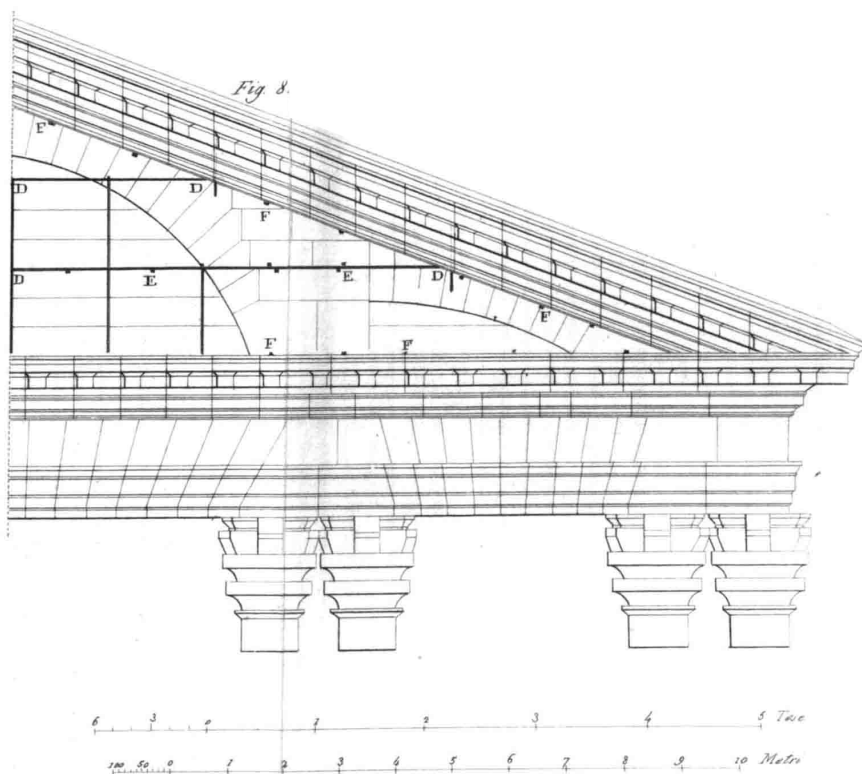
Armatura a catene, tiranti e ramponi del frontone che termina l'avancorpo centrale del colonnato del Louvre; elevazione dell'apparecchio della trabeazione e delle corsie della cornice rampante e prospetto degli archi di sollievo costituenti la struttura retrostante il timpano³².
